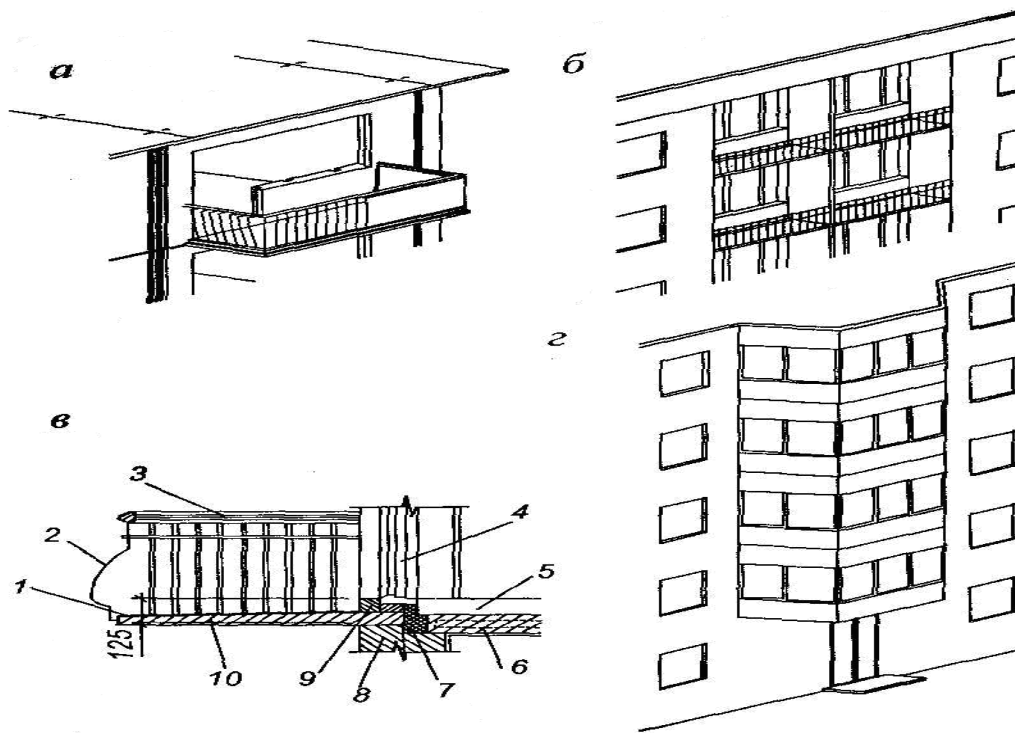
Конструктивні елементи стін і фасадів будівель: а – балкони; б – лоджія; в – схема влаштування балкона: 1 – підлога балконна по гідроізоляції; 2 – огорожа балконна; 3 – поручень; 4 – двері; 5 – підлога; 6 – залізобетонна плита перекриття; 7 – теплоізоляція; 8 – стіна; 9 – збірний поріг; 10 – залізобетонна балконна плита; г – еркер
